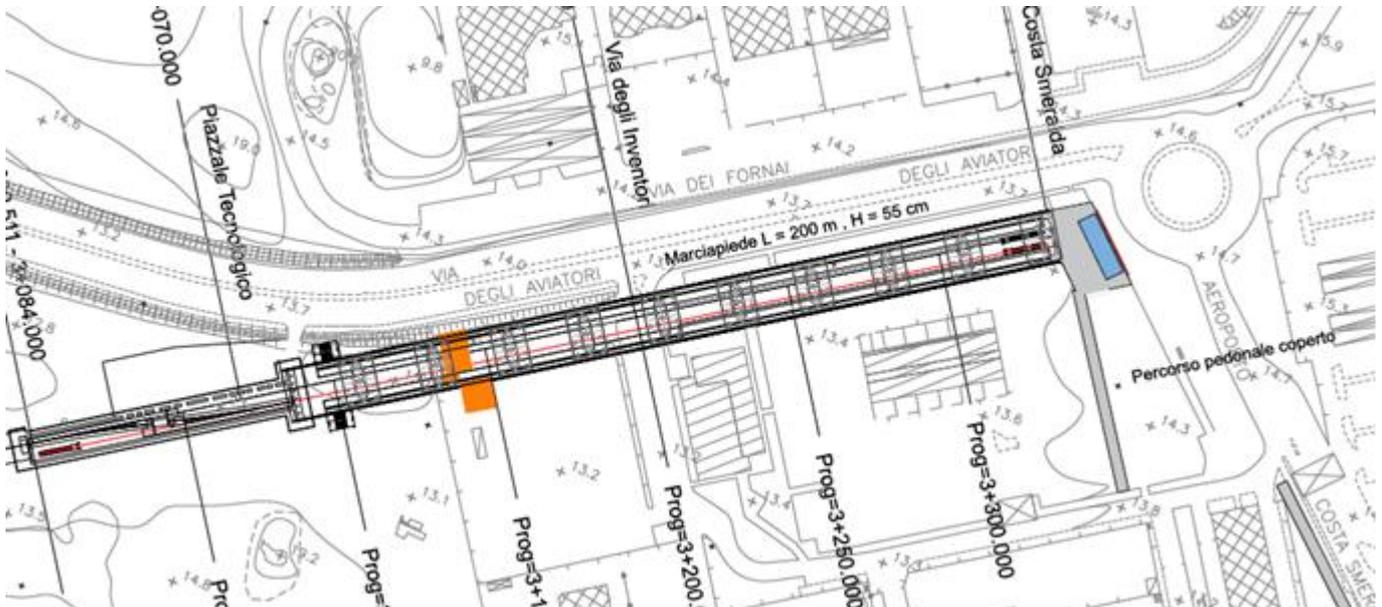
Planimetria di Progetto - Viadotto di stazione
